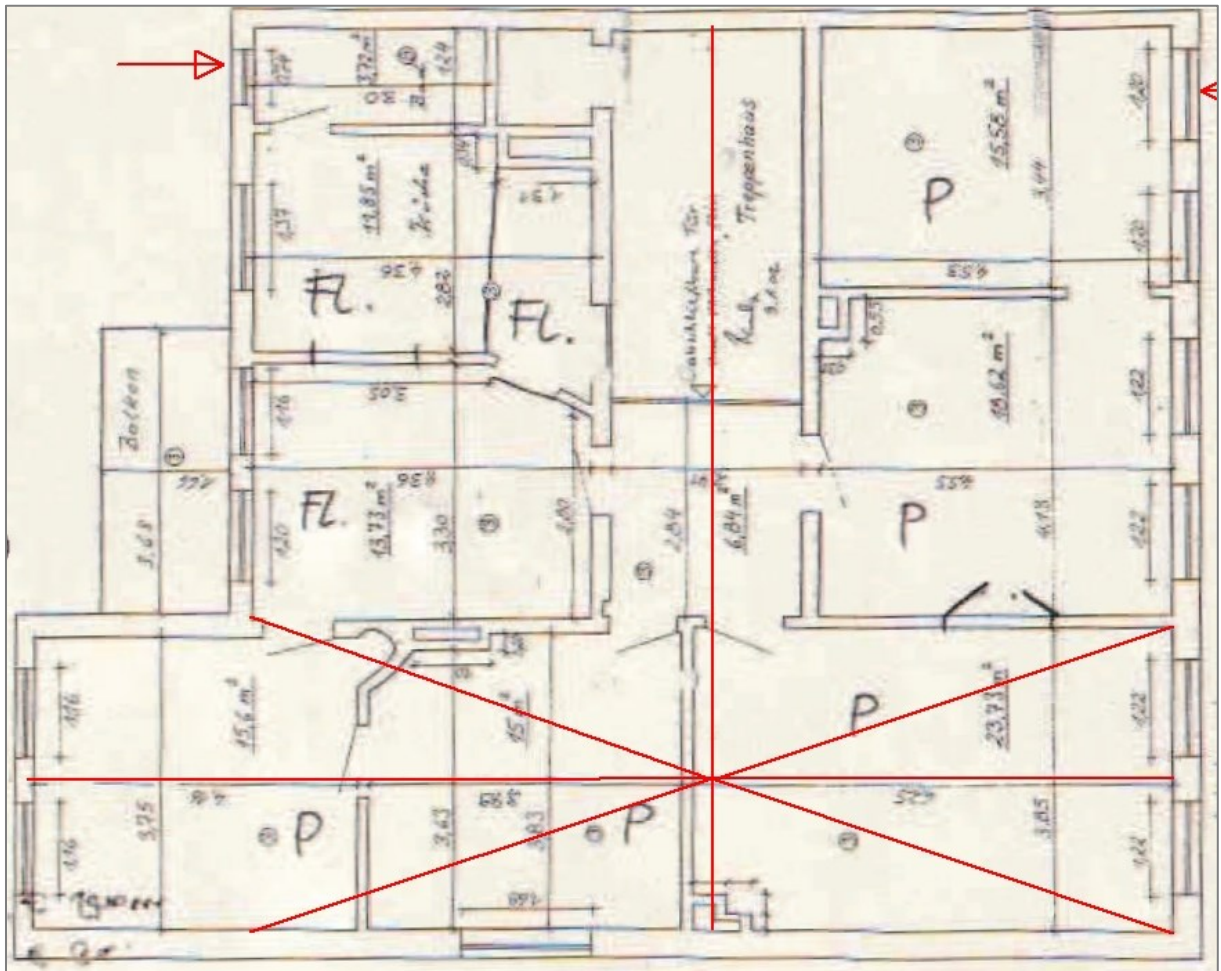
Grundriss Dieterichsstraße 26 2. OG, Maßstab im Original 1:100, der Plan ist nach Norden gedreht, die Vorgartenseite ist rechts, rote Linien: Firste und Kehlen
